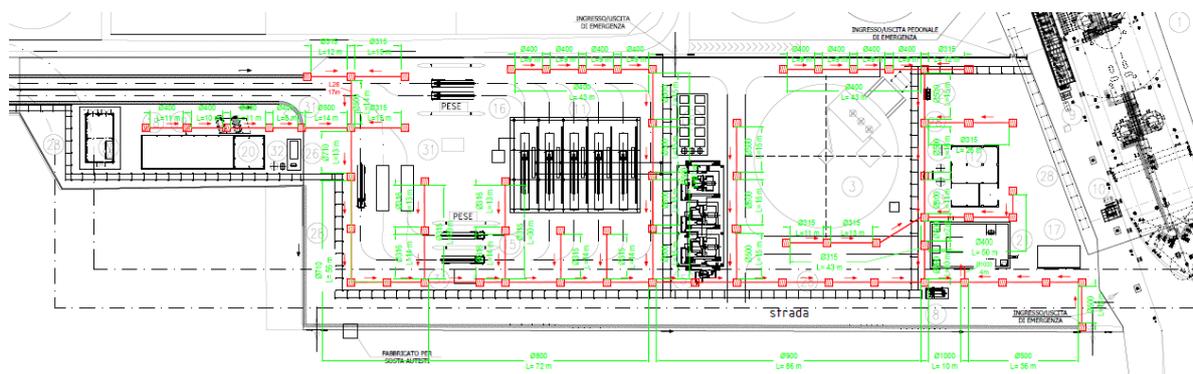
I: Planimetria Rete di Smaltimento Acque Meteoriche
